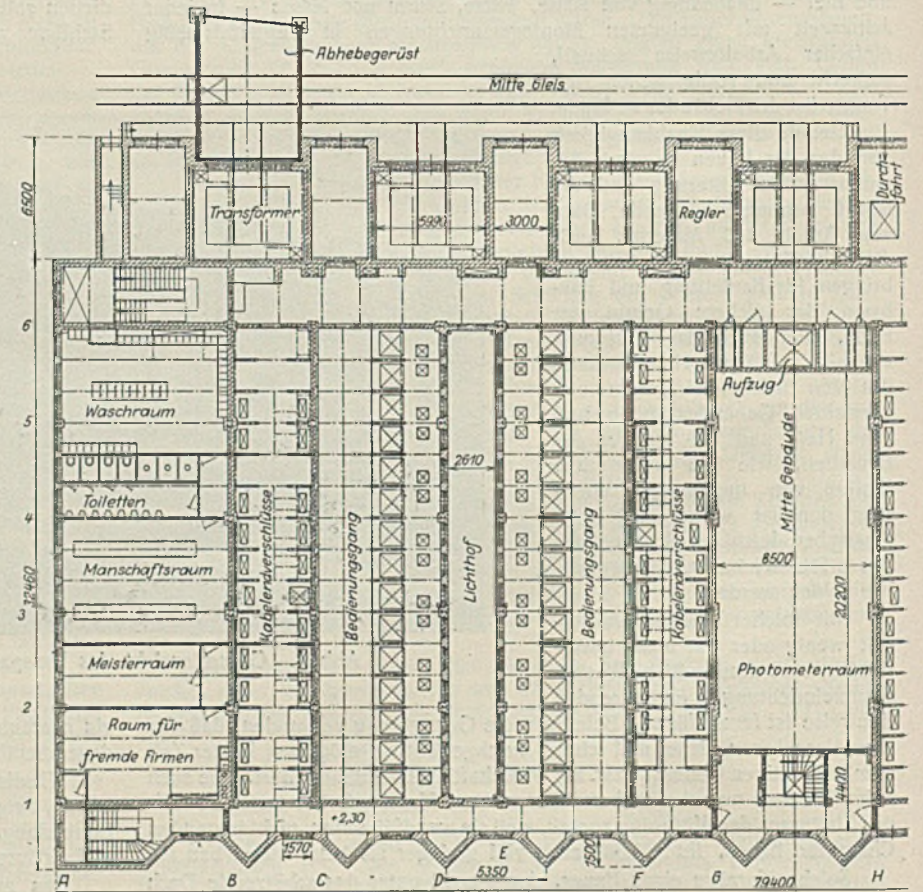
Grundriß (Schnitt a-a). Scharnhorst-Strasse
